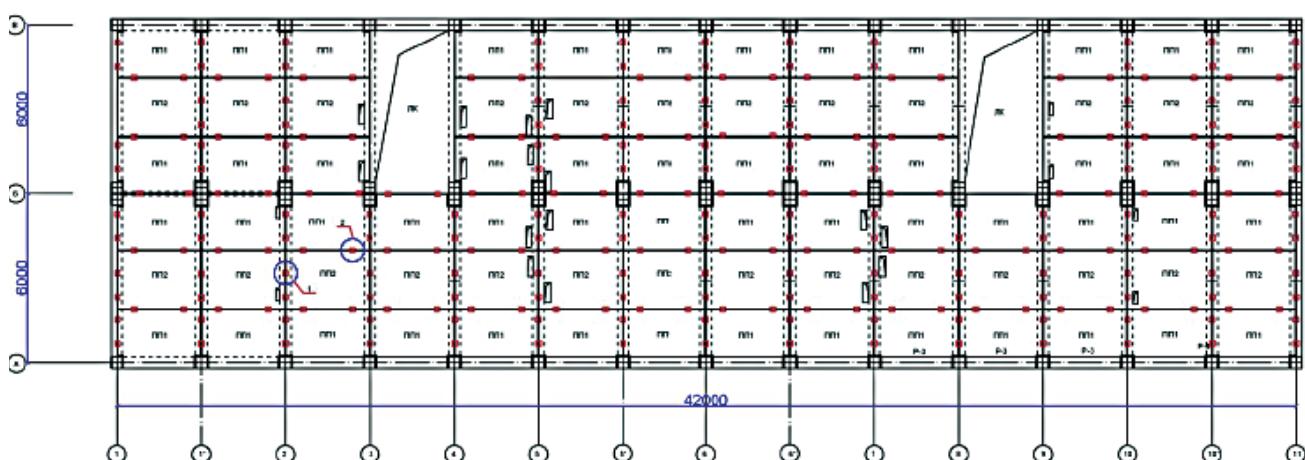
Схема расположения плит перекрытий на отм. 0,00
